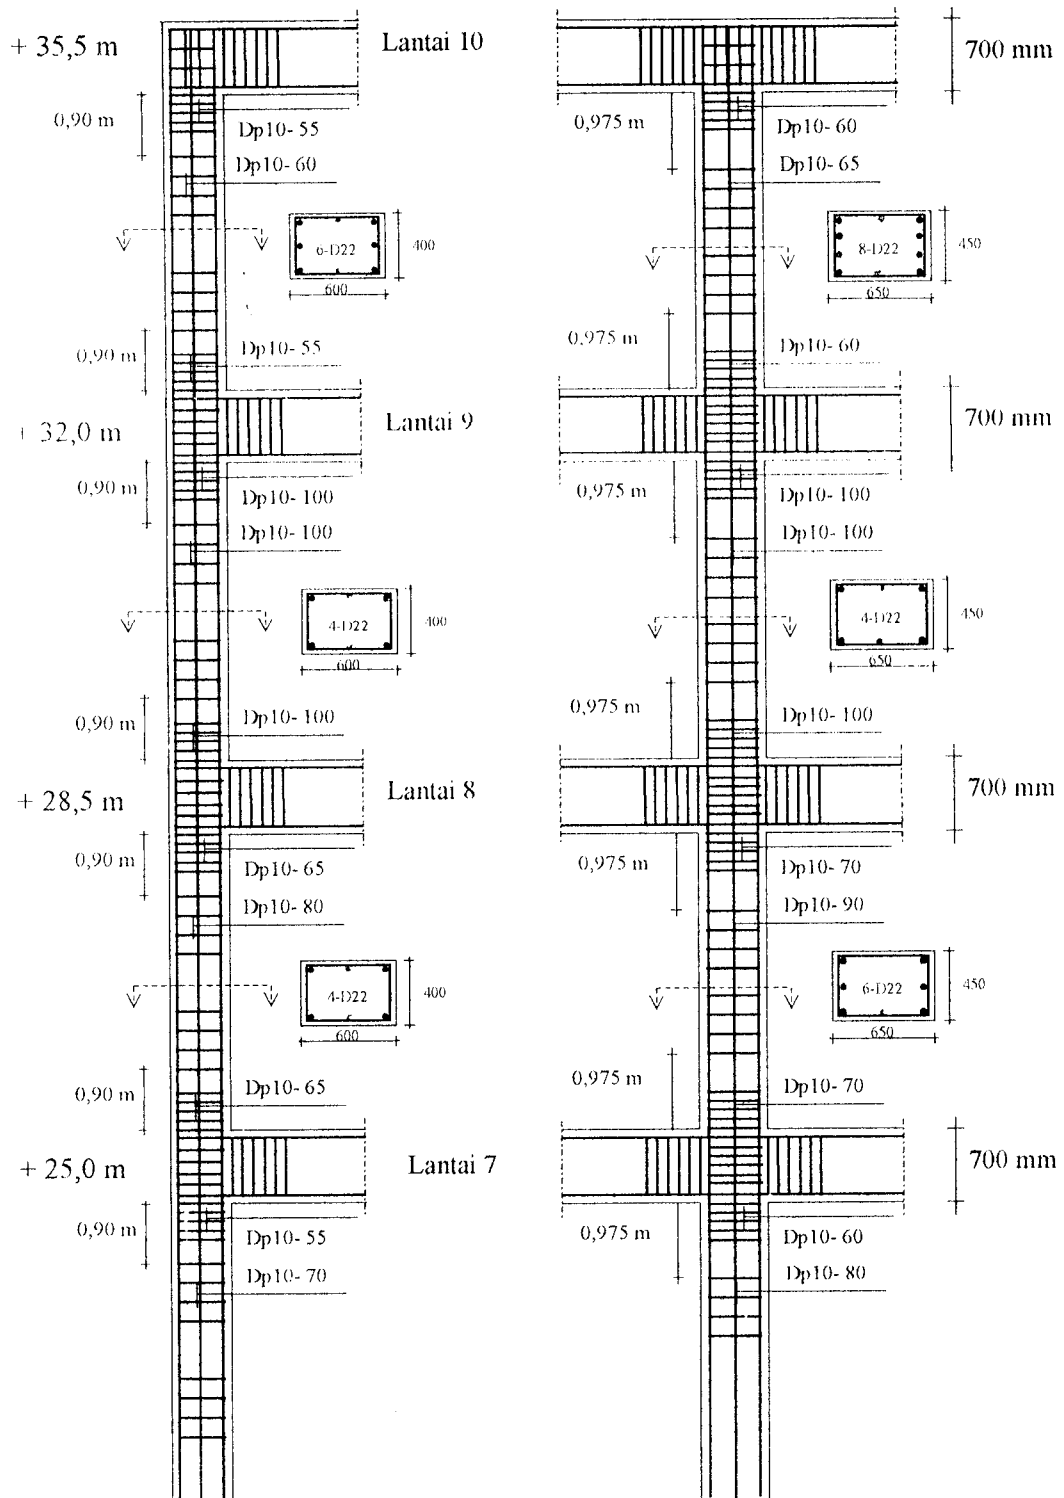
Detail Tulangan Balok Lantai 6 dan 10
